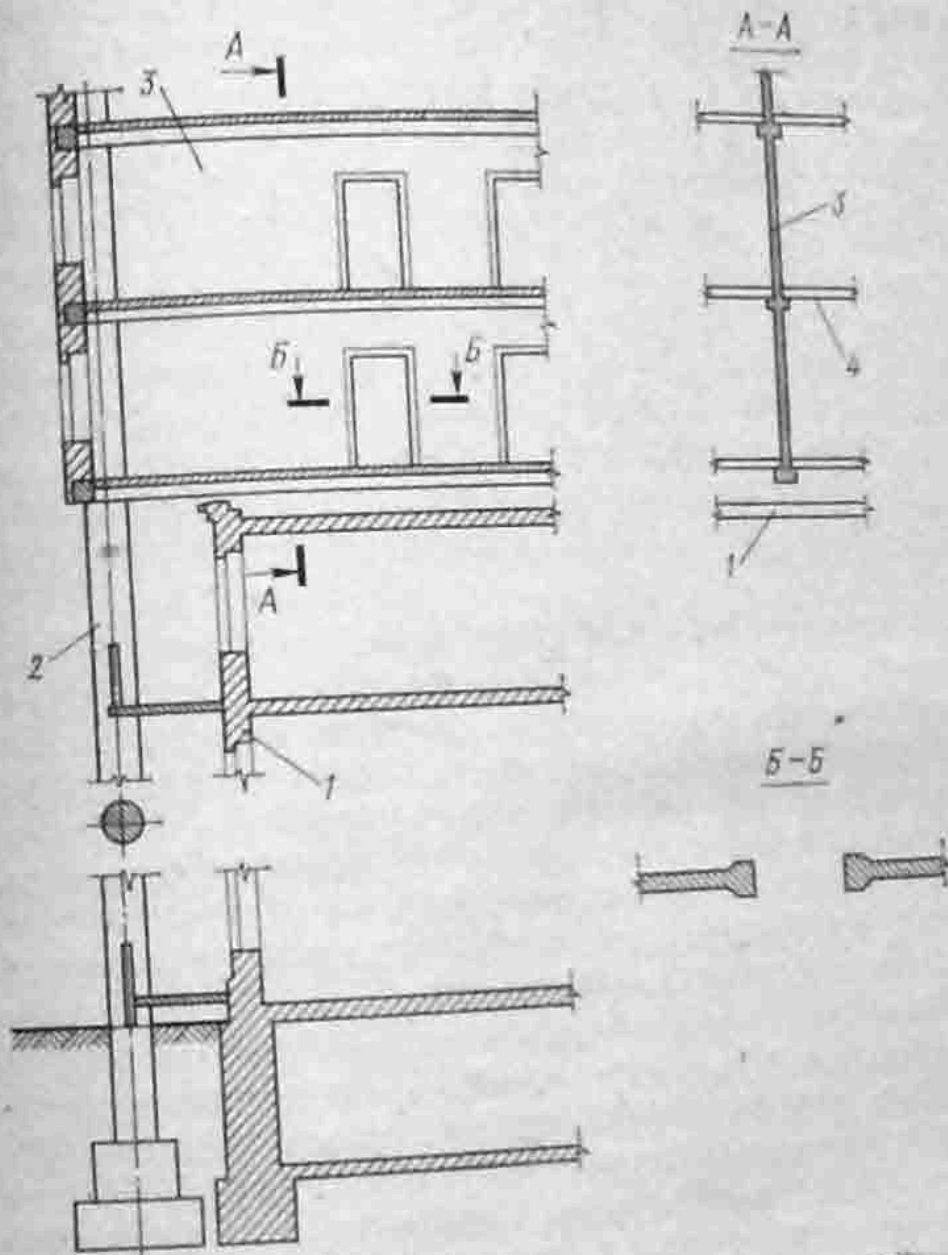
Надстройка здания, не опирающаяся на старую конструкцию (фасад и разрезы):
